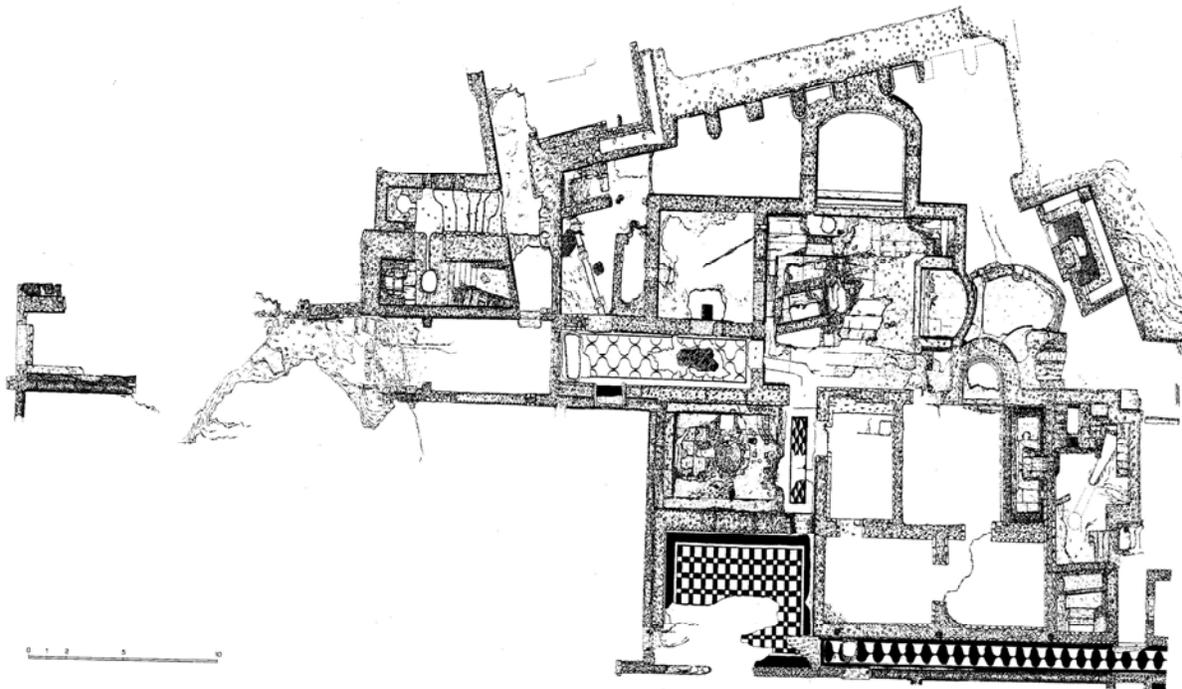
Villa de Livia, planta de la zona termal (plani metría: Sabatini)
